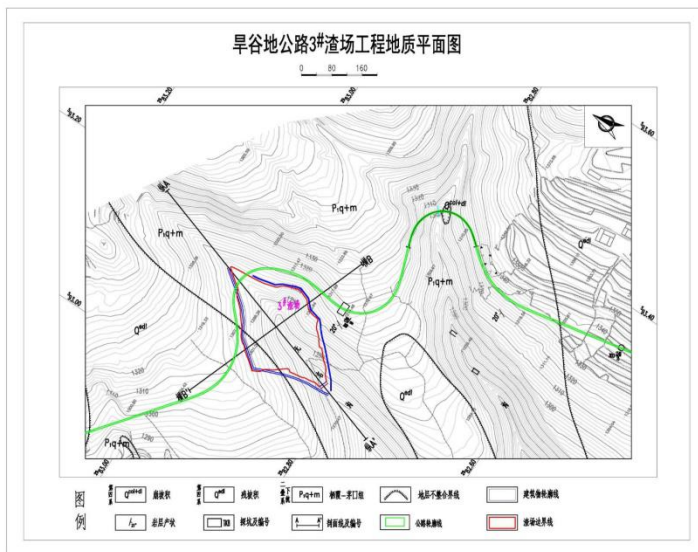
旱谷地公路 3#渣场工程地质平面图
